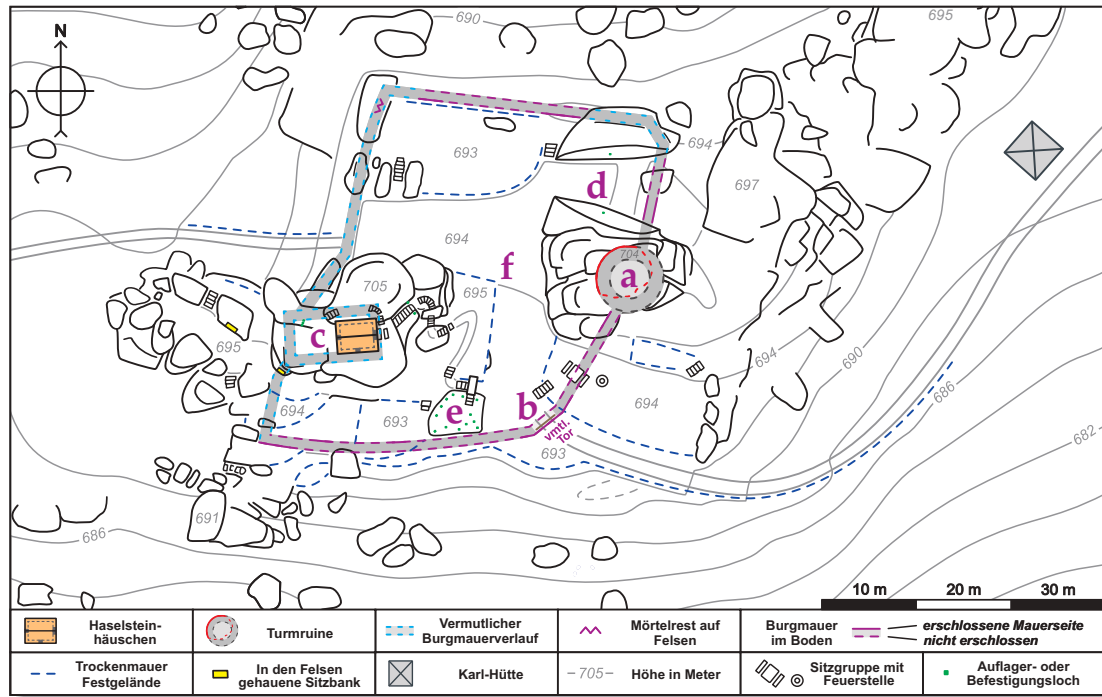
Grundriss der Burganlage (14./15. Jh) und des Festgeländes (19./20. Jh).
